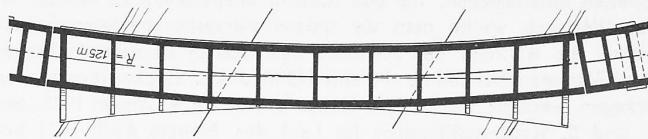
Grundriss (1 : 500) der Eisenbahnbrücke bei Klosters; R = 125 m.
